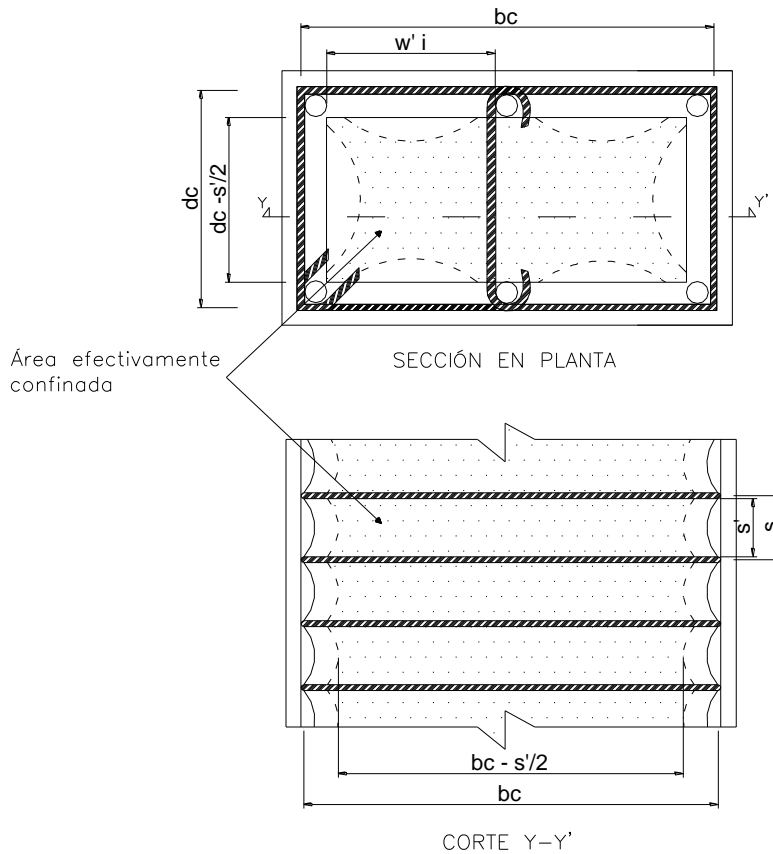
Núcleo efectivo de concreto confinado para una sección rectangular/cuadrada.
